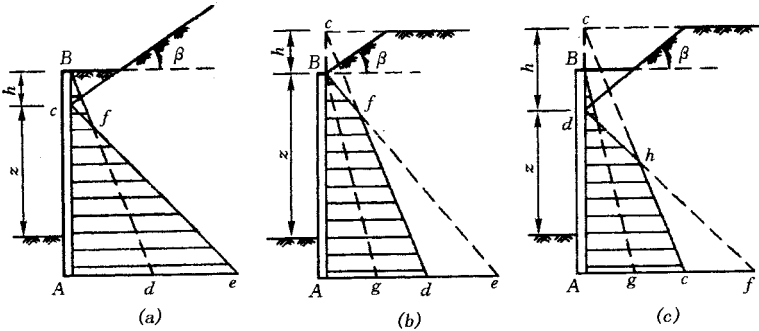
地面非水平时支护结构上主动土压力的近似计算
